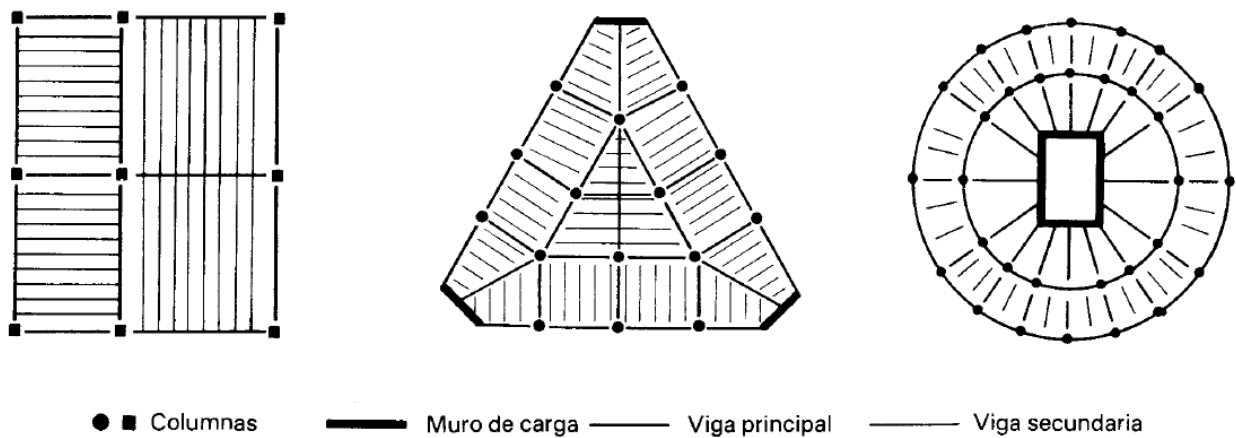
Arreglos de vigas secundarias y principales en sistemas de piso de planta regular e irregular.
